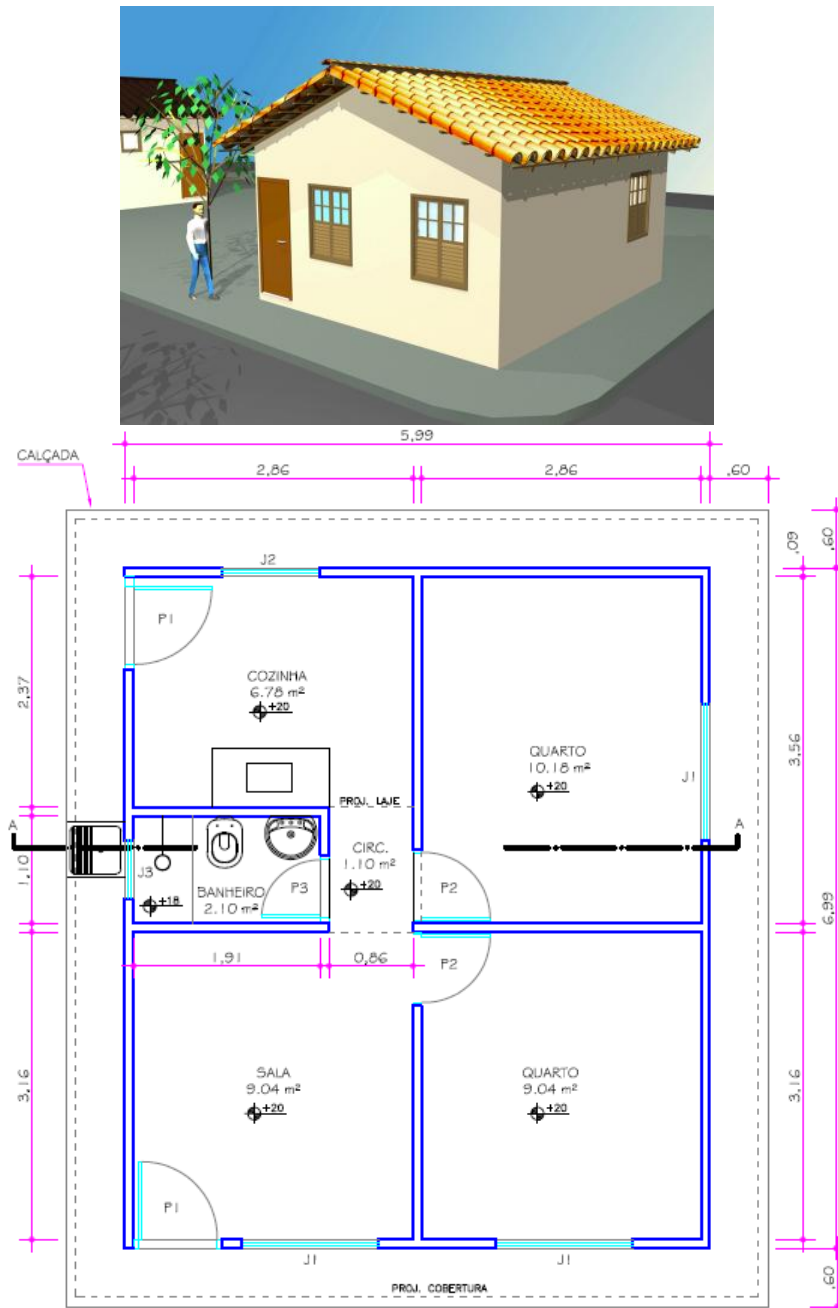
Perspectiva e Planta Baixa Projeto Padrão Caixa (CADERNOS CAIXA, 2007)
